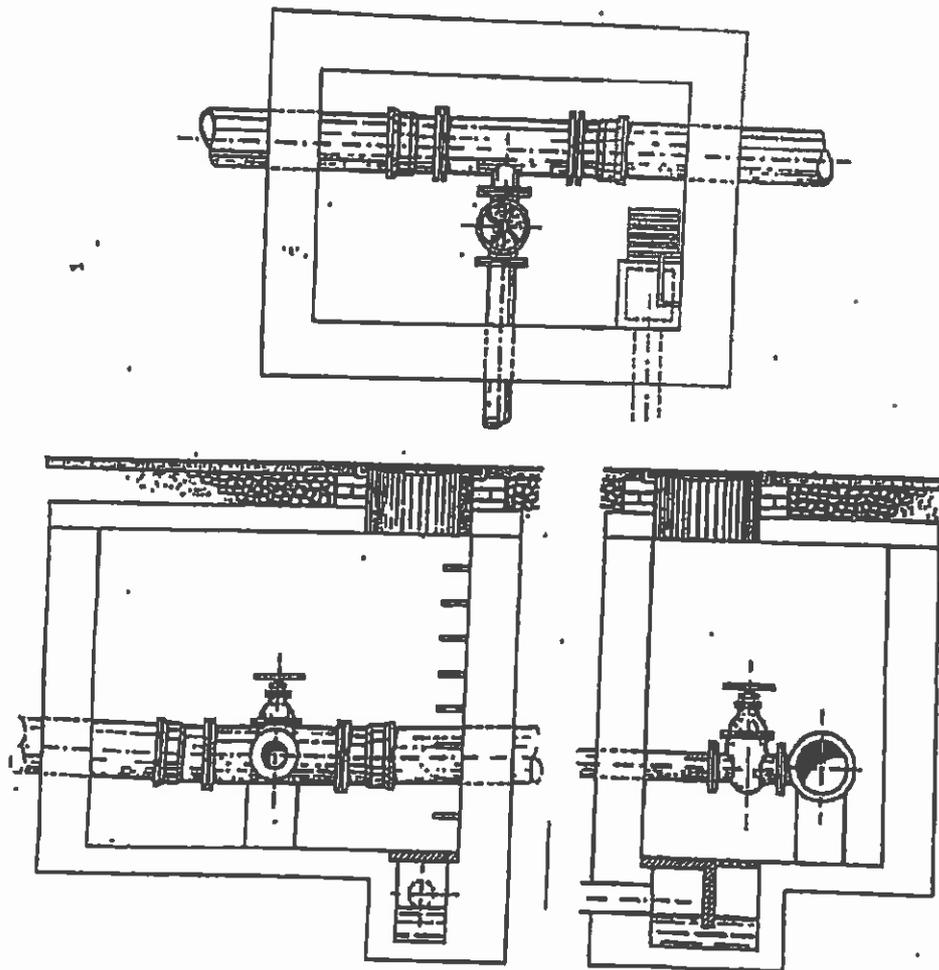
Pozzetti per gli scarichi delle tubazioni: pianta, sezione longitudinale e sezione trasversale.
